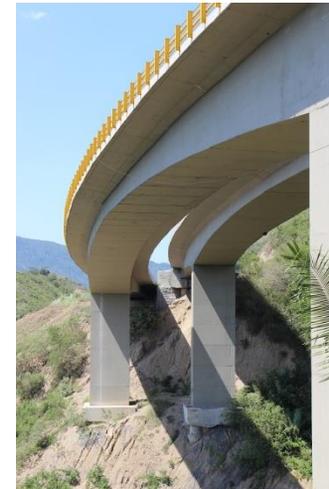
14 Foto del perfil general del puente VIADUCTO LAS LAJAS – CALZADA IZQUIERDA. . Fuente:(AGENCIA NACIONAL DE INFRAESTRUCURA, 2010)
